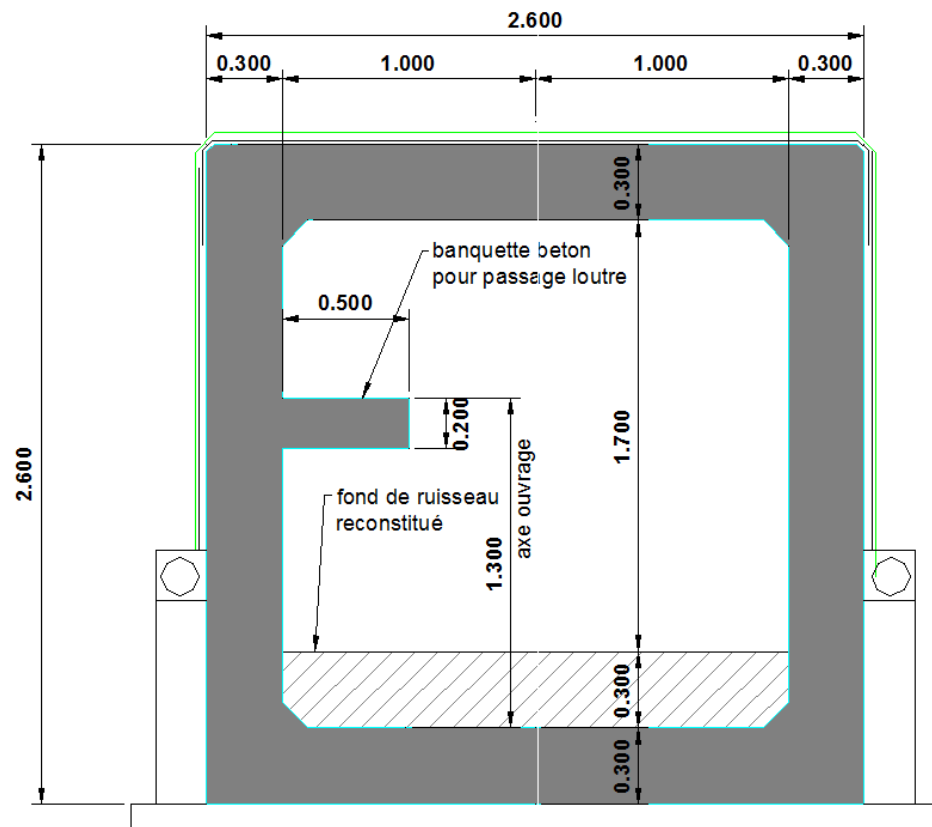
Coupe transversale de l'OH (source ARCADIS)
